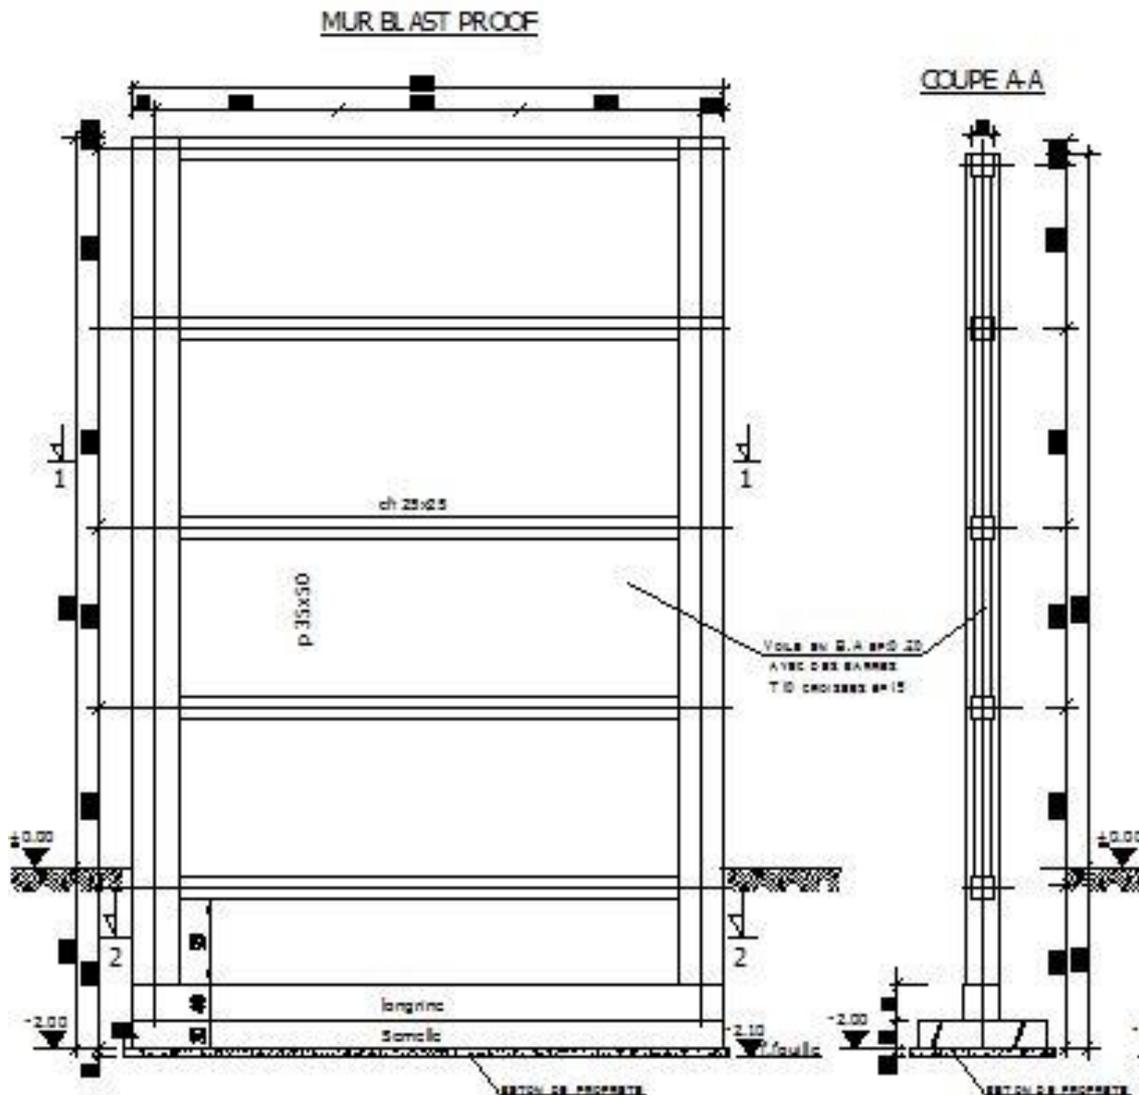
Structure du mur Blast proof avec poteaux et poutres
